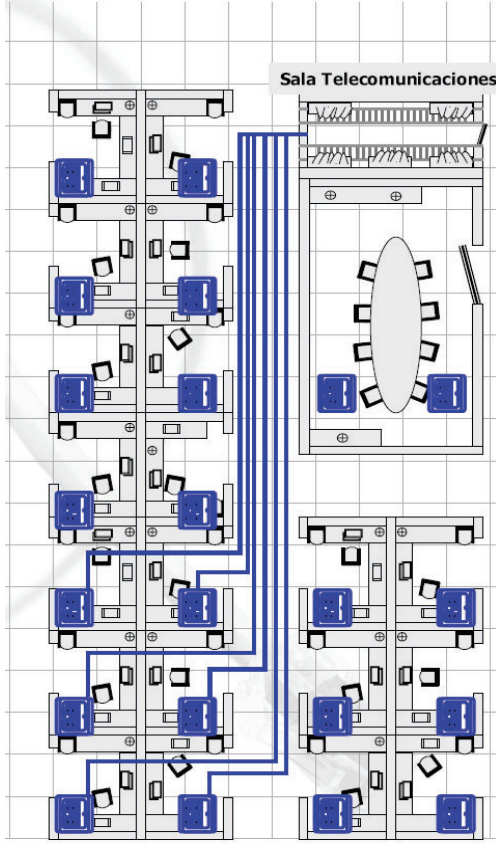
Subsistema horizontal con cableado directo a las TTs
